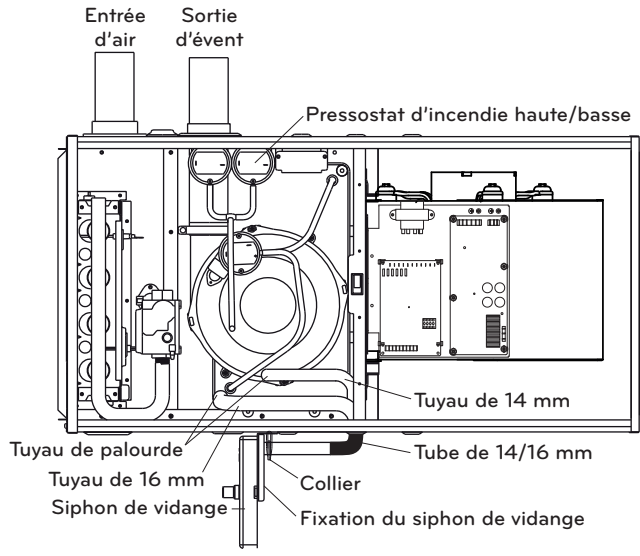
Installation horizontale sur le côté gauche, ventilation par le panneau latéral
